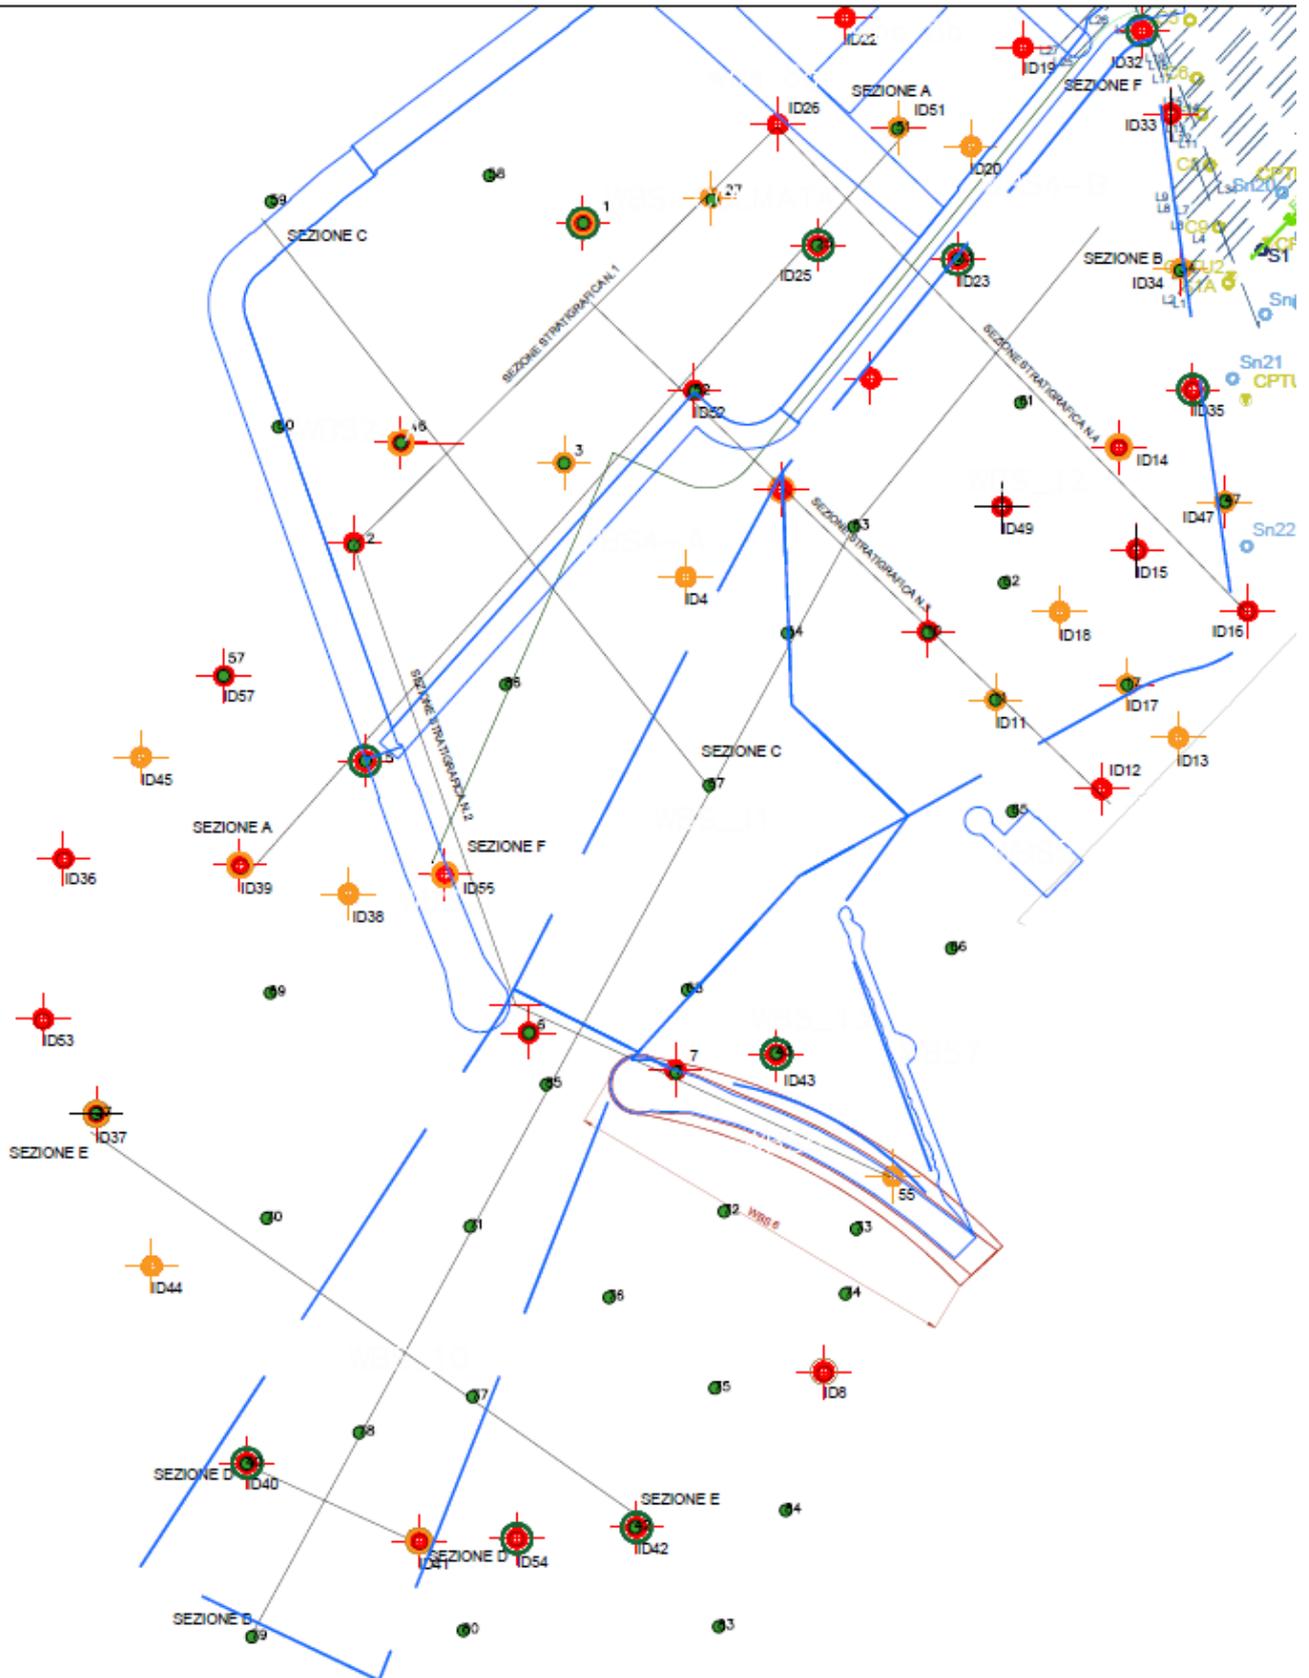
Schema planimetrico con traccia delle sezioni geologiche
